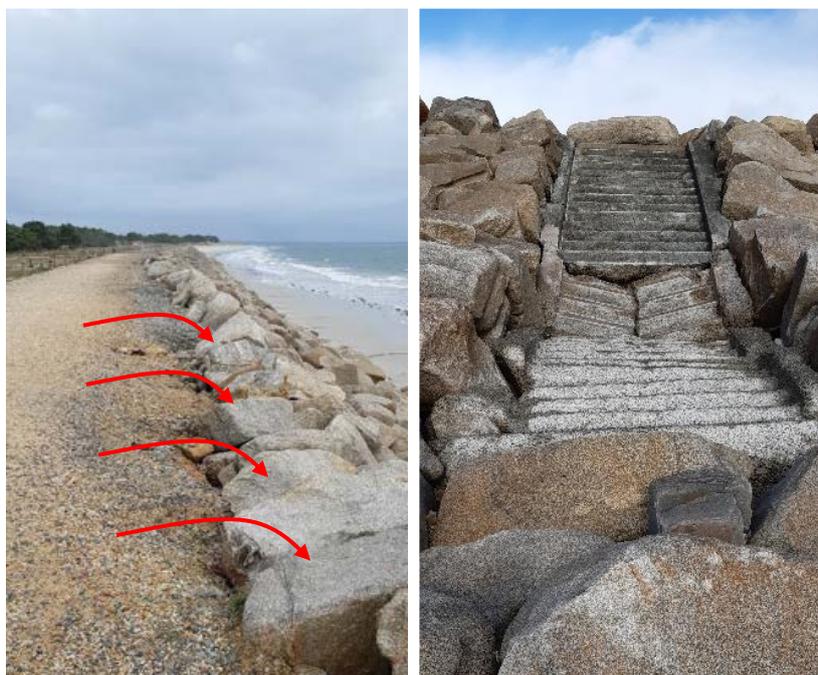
Soutirage des matériaux de remblai et désordre sur l’escalier
